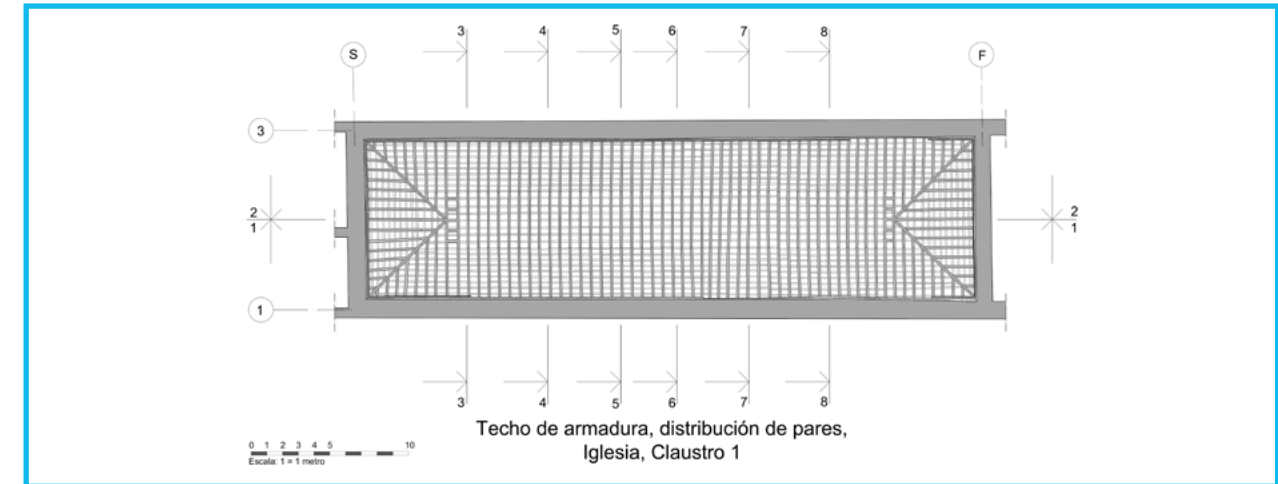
Planta del techo de armadura de la iglesia donde se muestra la distribución de los pares
